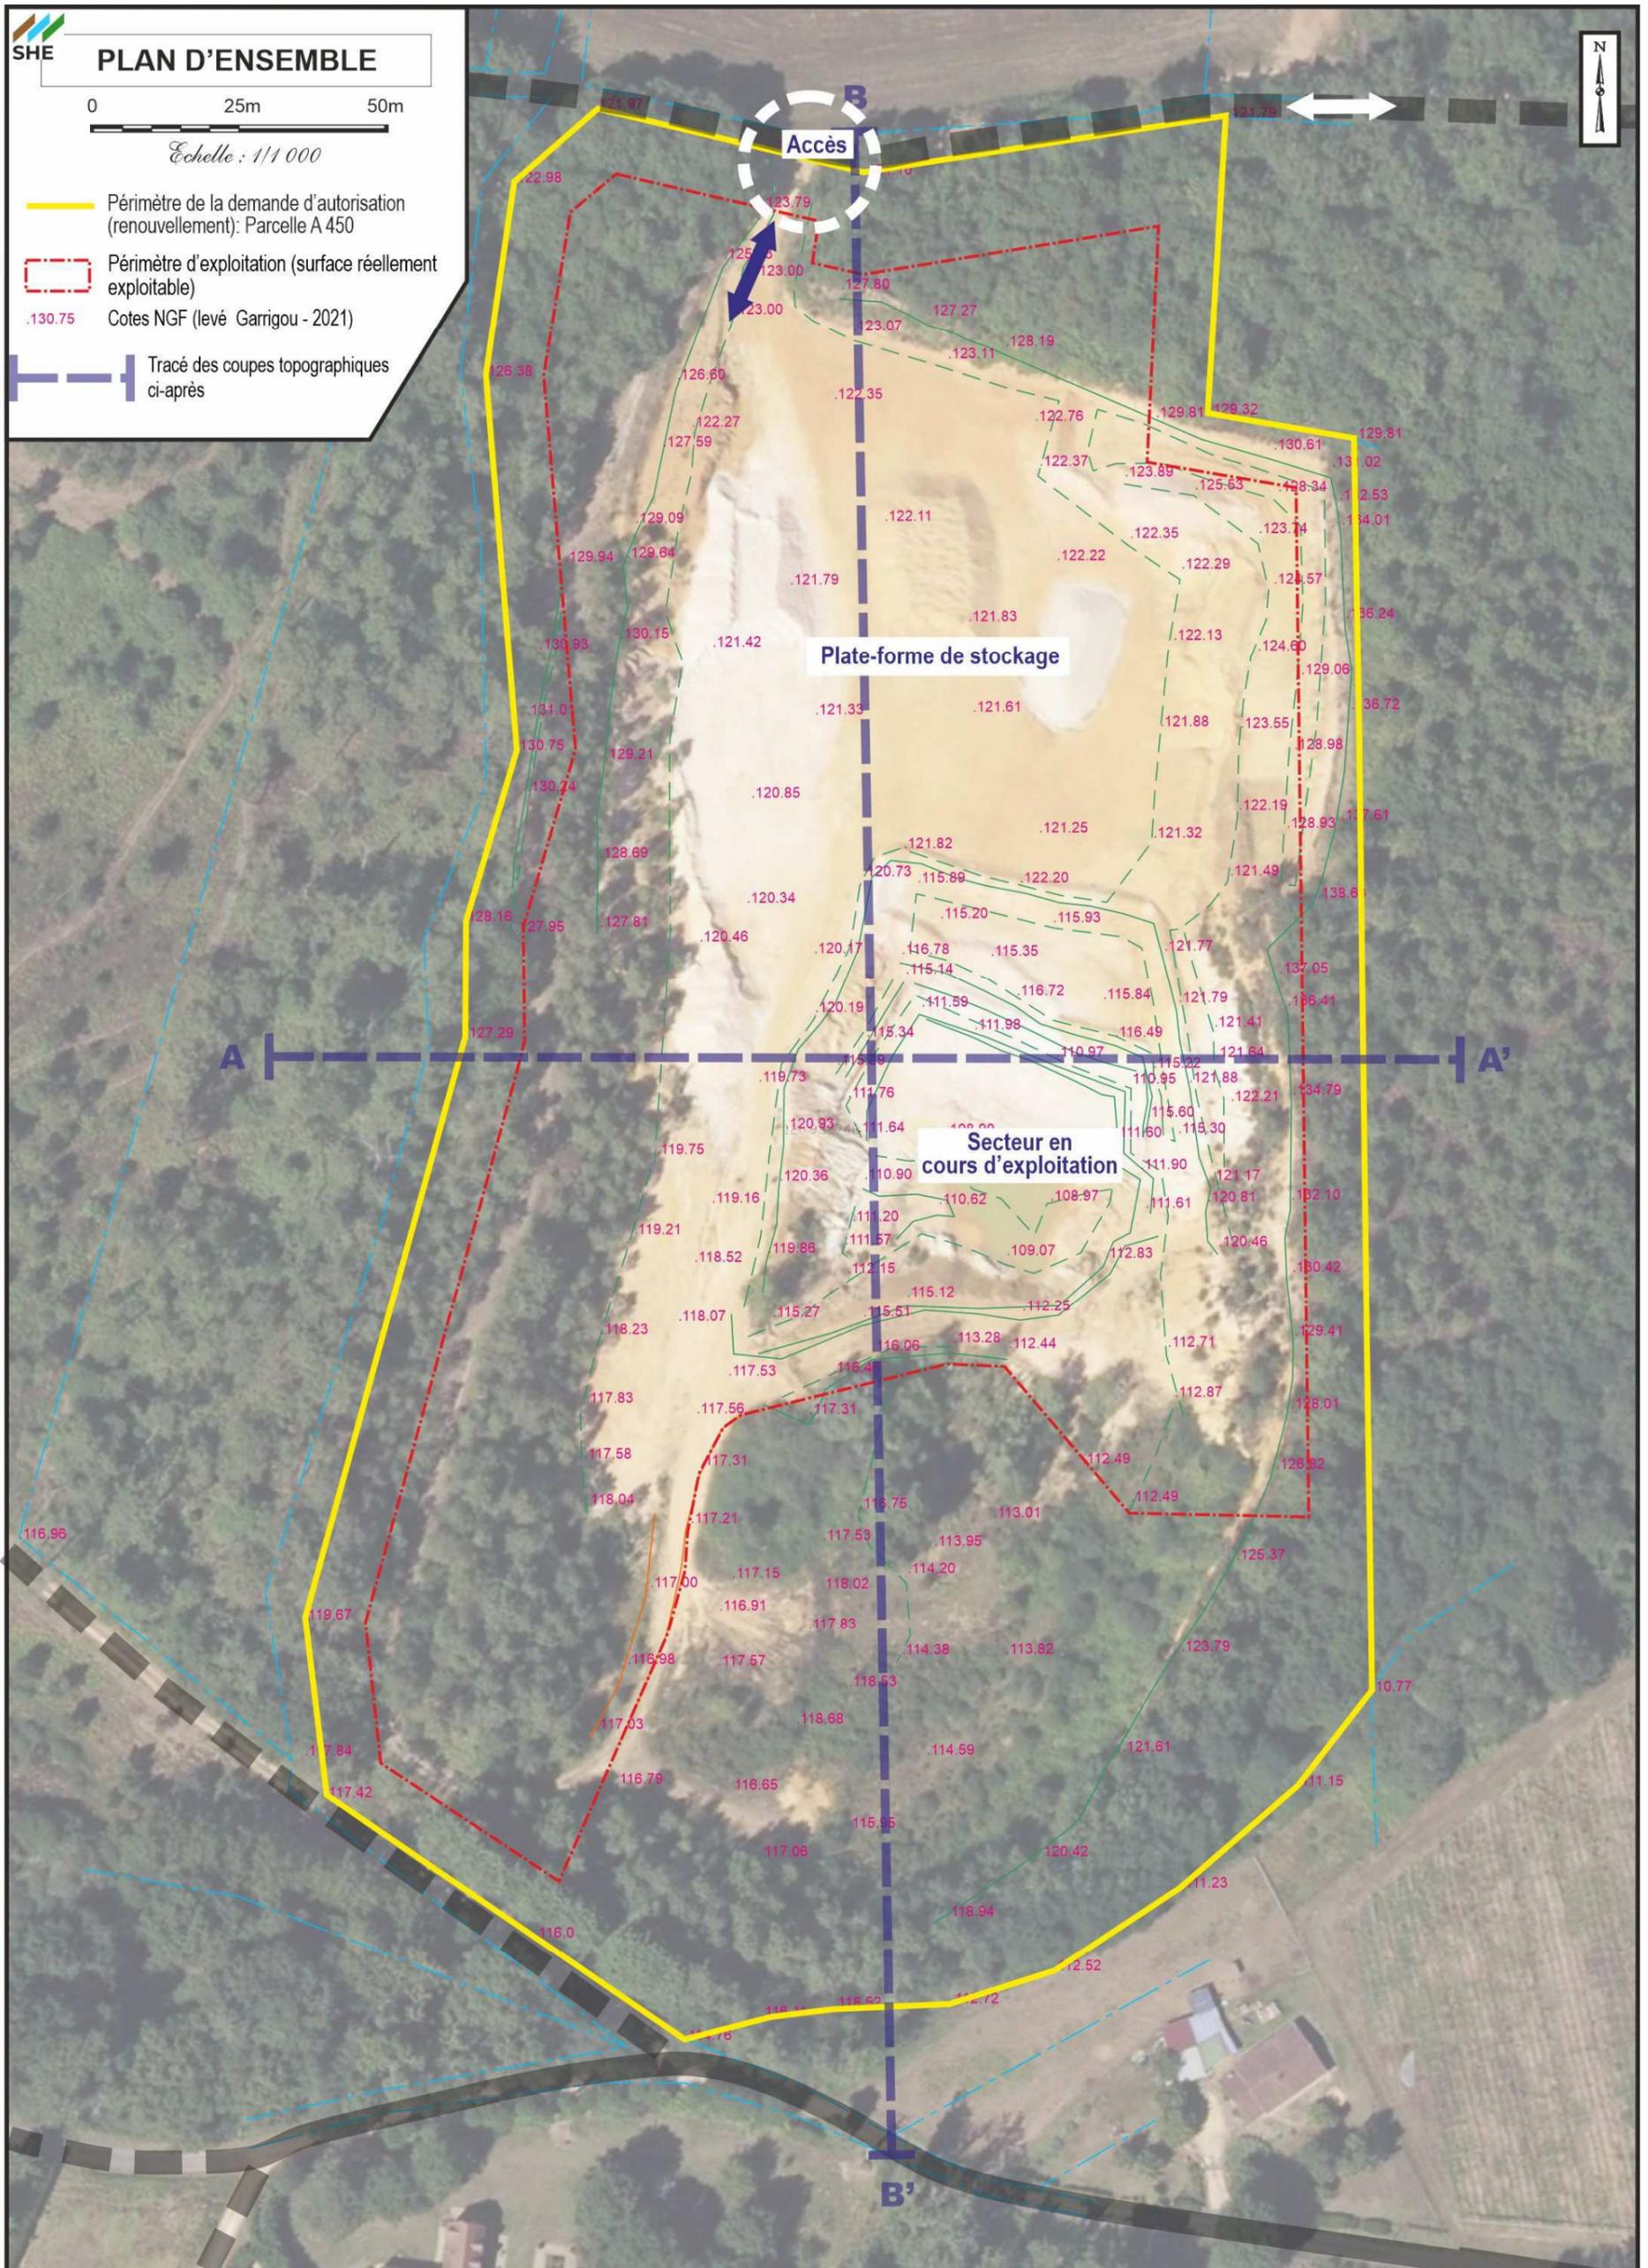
Plan d'ensemble du site – Echelle 1/1 000
